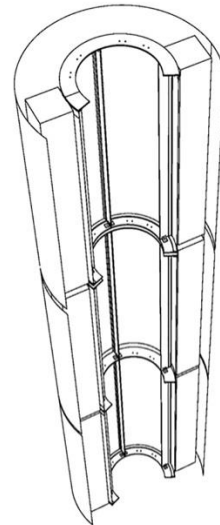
Detalle en axonometría seccionada del prototipo de los pozos de luz.
